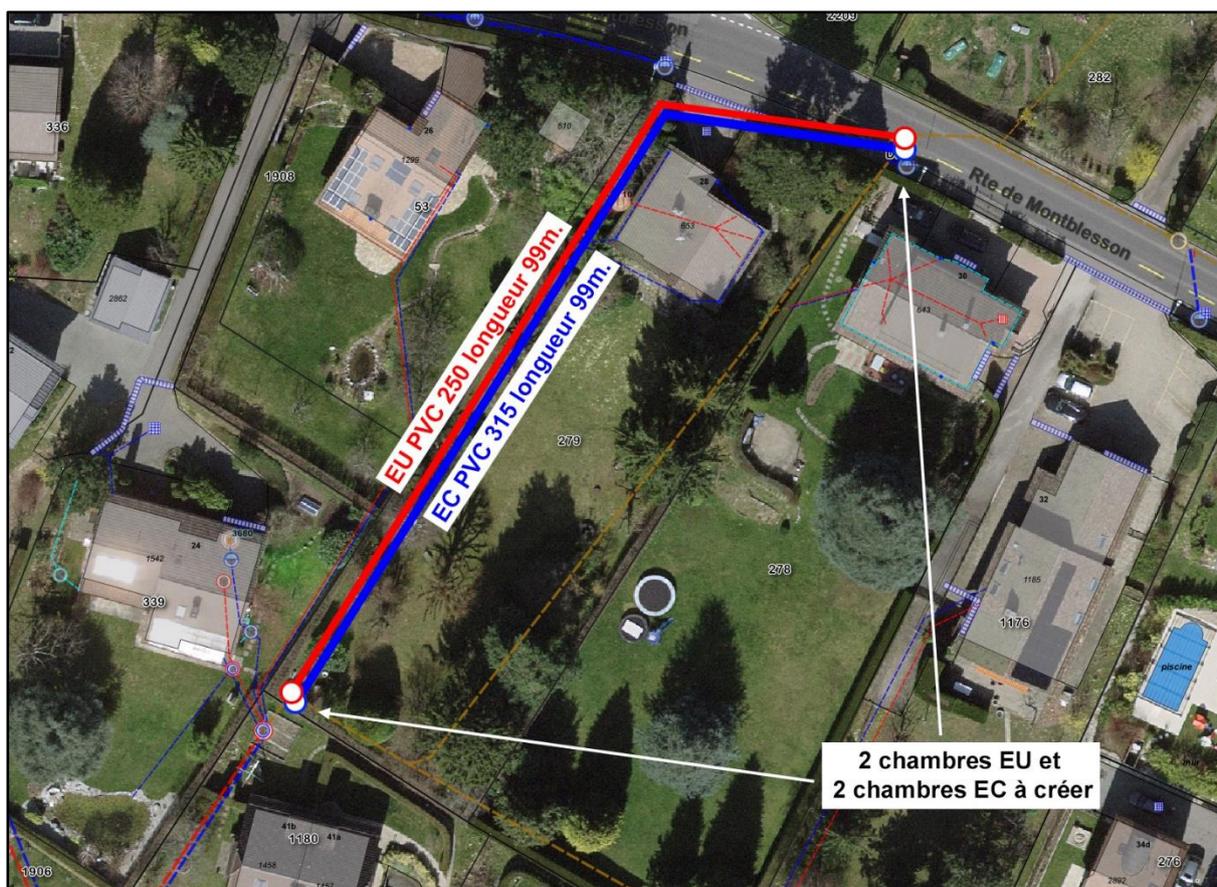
Plan des travaux du secteur Montblesson/Planches
